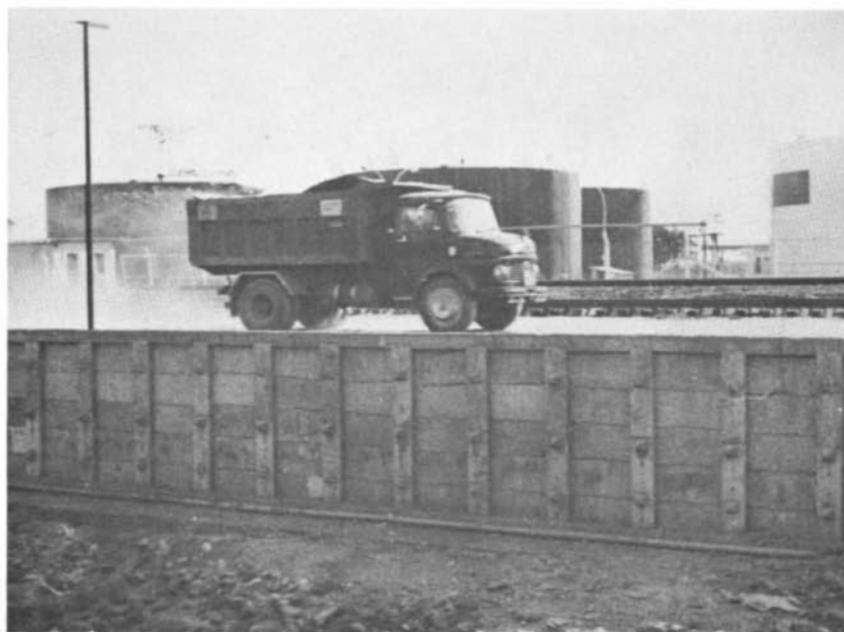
Mesma obra da foto 9, observando-se a pista e a linha férrea.
